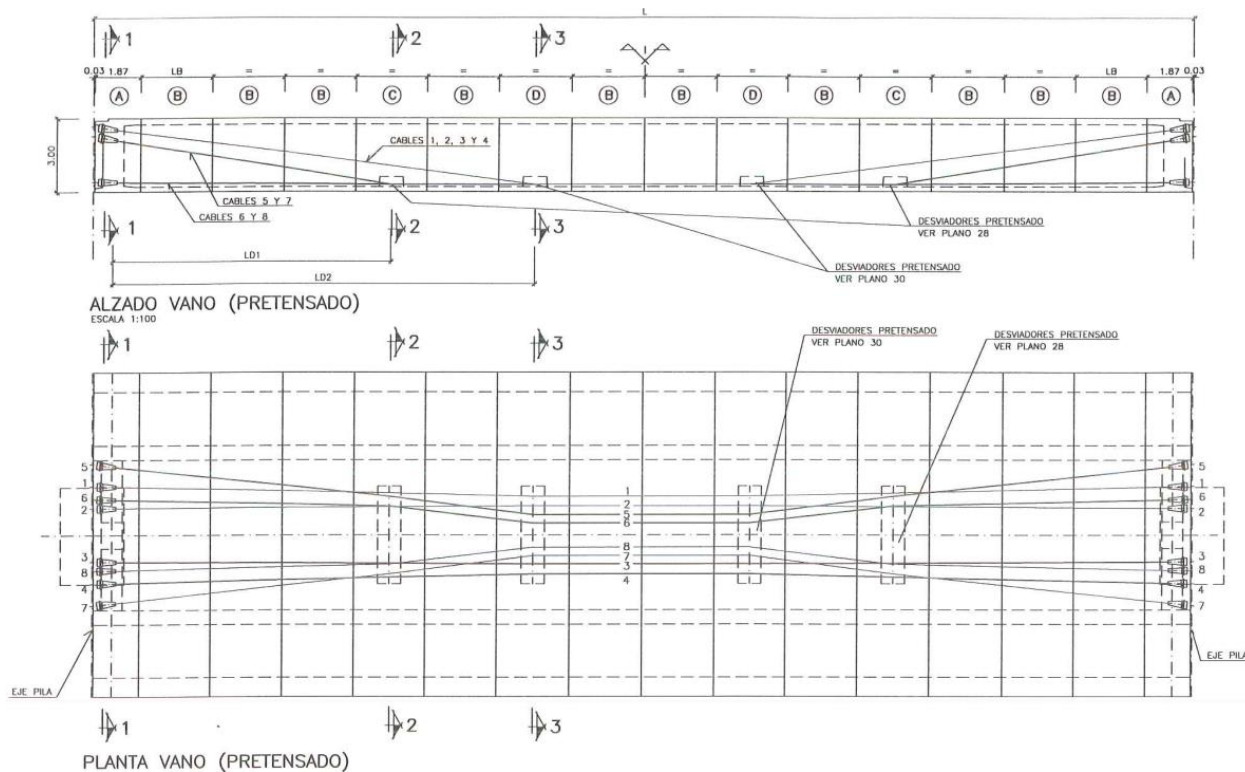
Alzado y planta del vano tipo con sus dovelas constitutivas y pretensado exterior. (Fuente: [2]).
